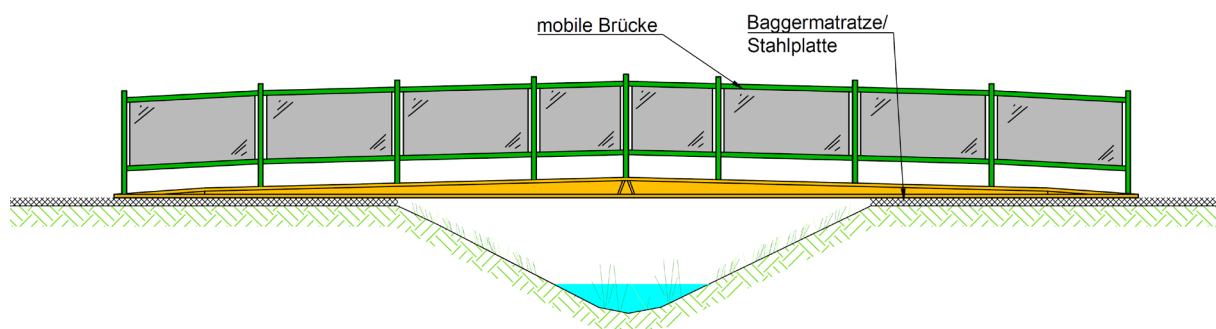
Prinzipskizze zum Einsatz mobiler Brücken
